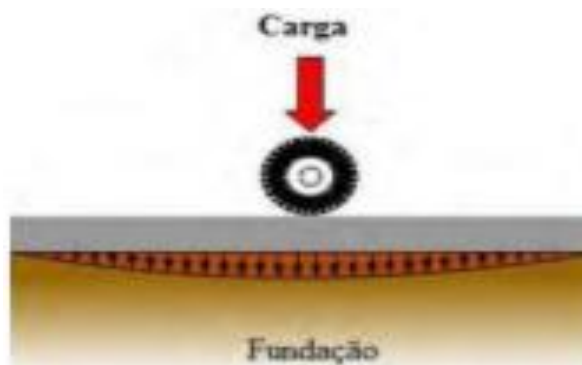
Distribuição das Tensões no Pavimento Rígido
